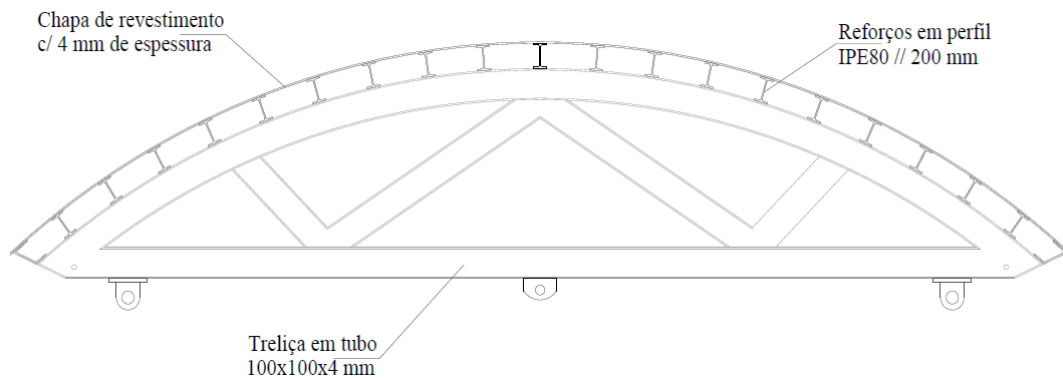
Secção transversal dos painéis metálicos (Fonte: Projeto da cofragem)
